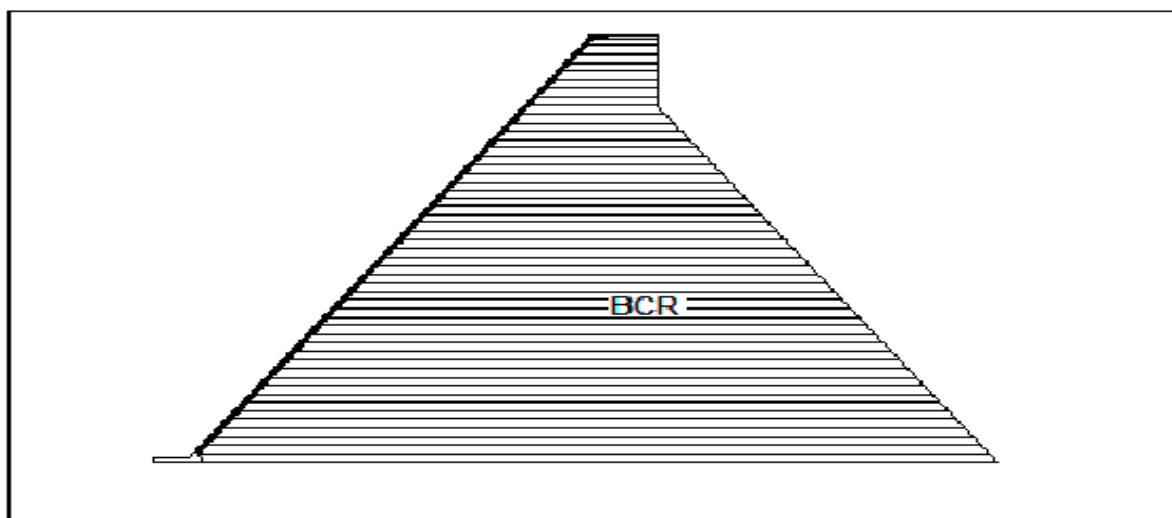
coupe type d'une digue en BCR type remblai dur
